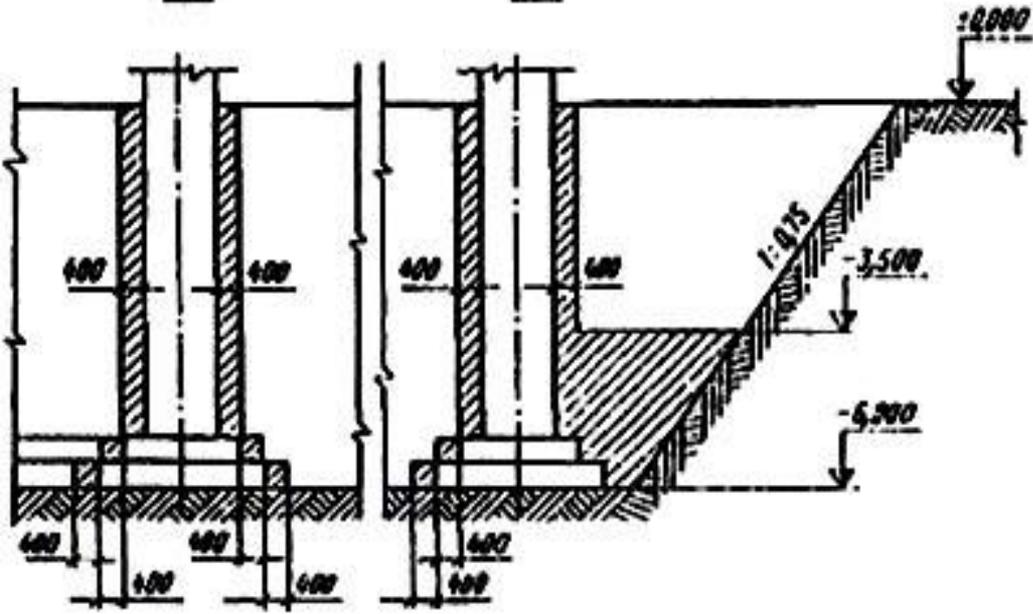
Схема обратной засыпки связным грунтом котлована с установленными колоннами:
